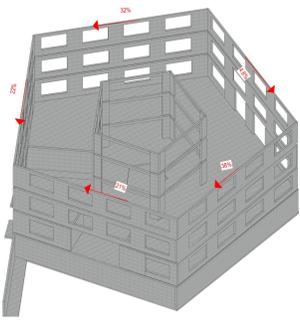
3D-Rohbaumodell mit Aufteilung der horizontalen Lasten (Allplan 2019).
